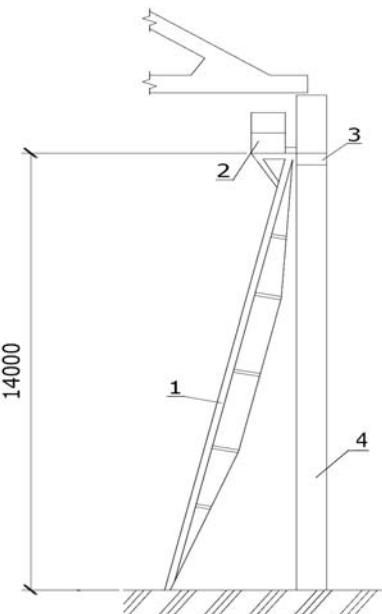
Монтажные лестницы с площадками с несущей конструкцией в виде шпренгеля:
